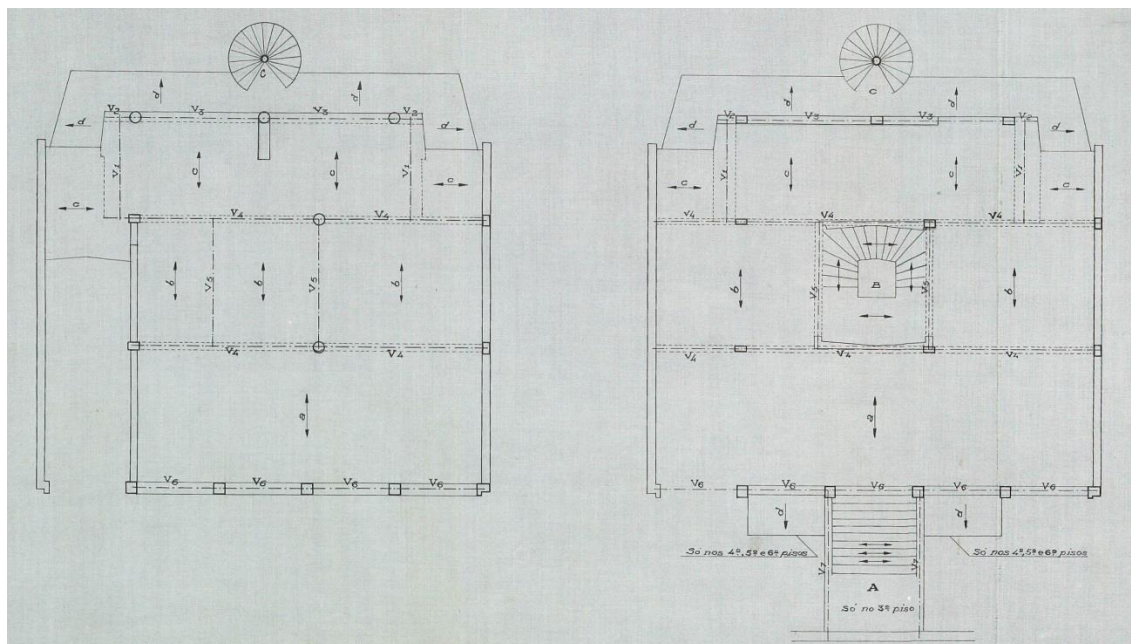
Plantas estruturais onde é visível a combinação de paredes resistentes de alvenaria de granito com pilares e vigas de betão armado. Mais uma vez a tradição e a modernidade em conjunto.
